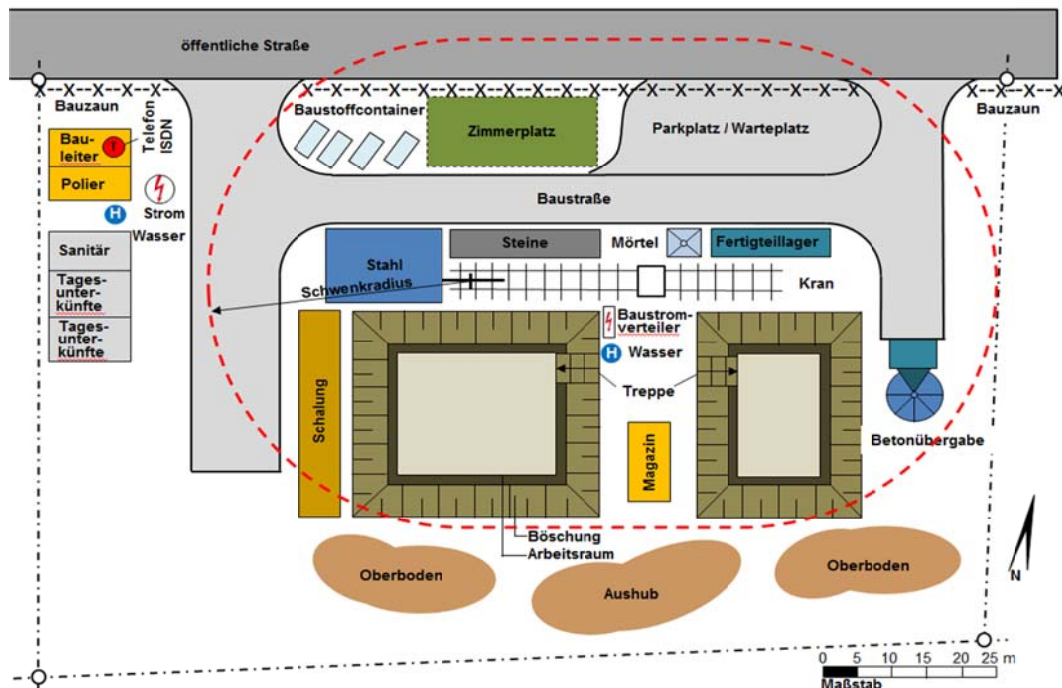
Beispiel für einen Baustelleneinrichtungsplan
